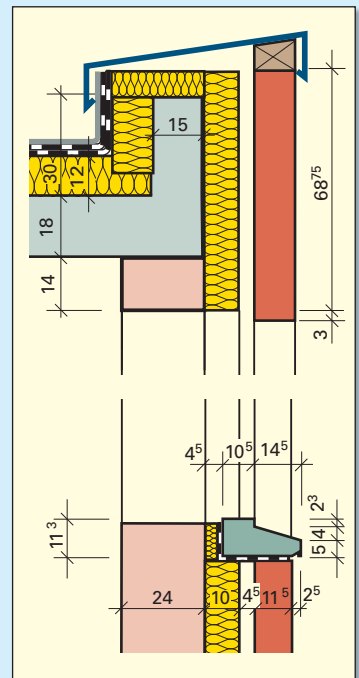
Fassadenschnitt mit Fensteröffnung und Flachdach
